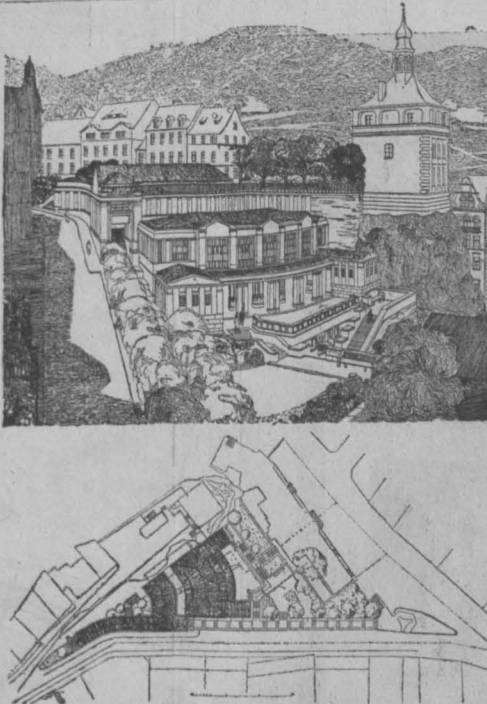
Entwurf VII. Schaubild und Grundriß.
